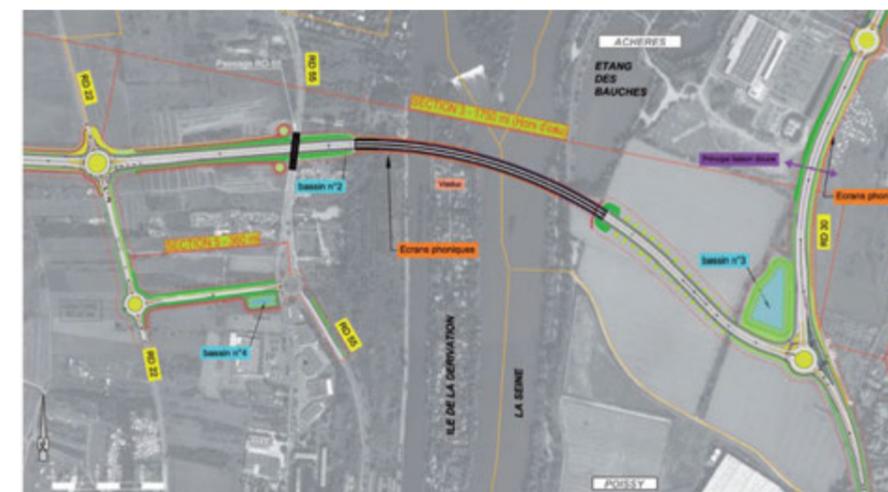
Plan Général des Travaux liaison RD30 - RD190
